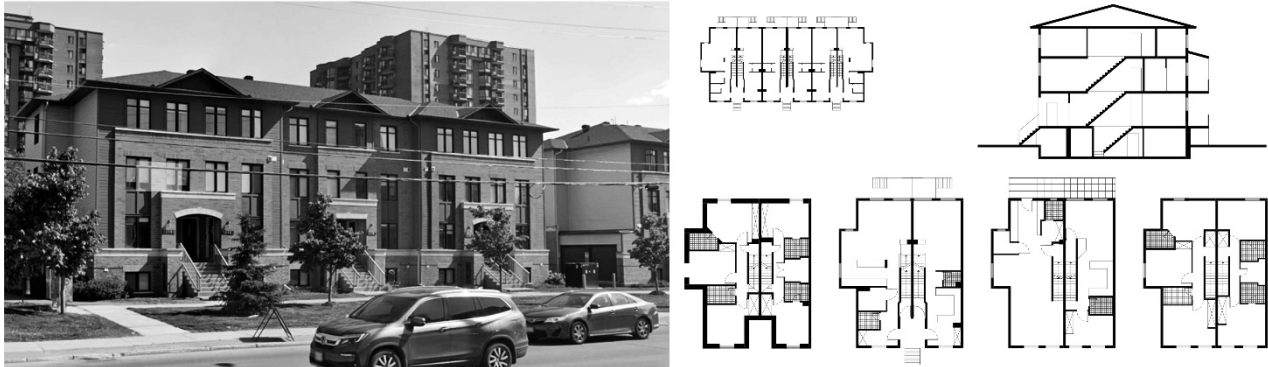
4-поверховий секційний будинок (Terraced Apartment). Загальний вигляд зі сторони магістралі, план поверхів, розріз, схема блокування. (Фото [15], креслення Яблонська Г.Д.)
